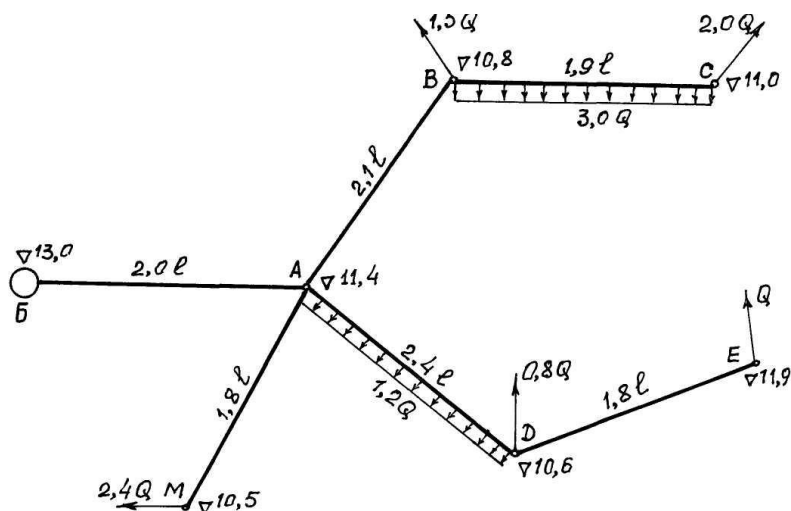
Расчетная схема разомкнутой водопроводной сети
